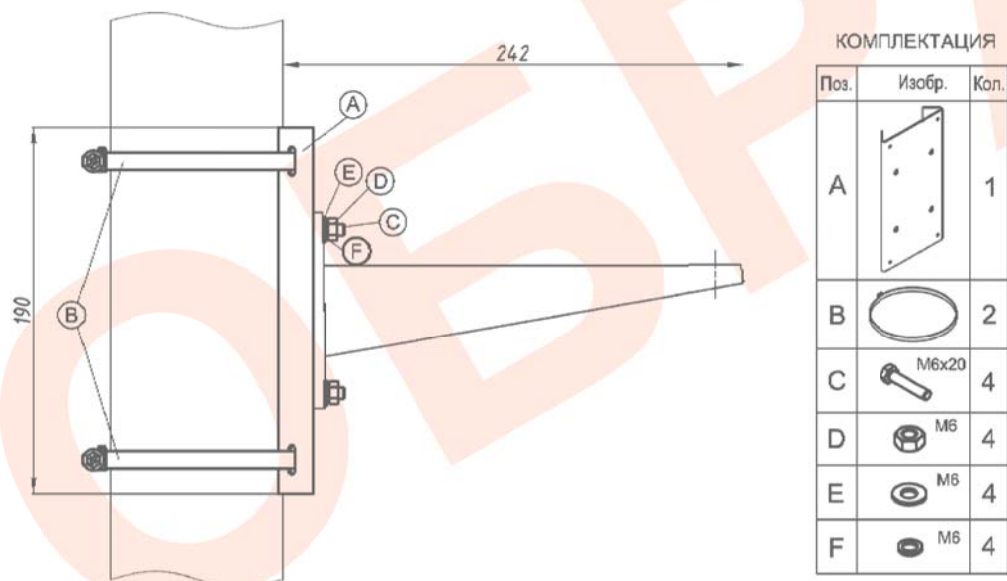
Монтаж кронштейна ТГБ-3 на опору (круглую или квадратную)
